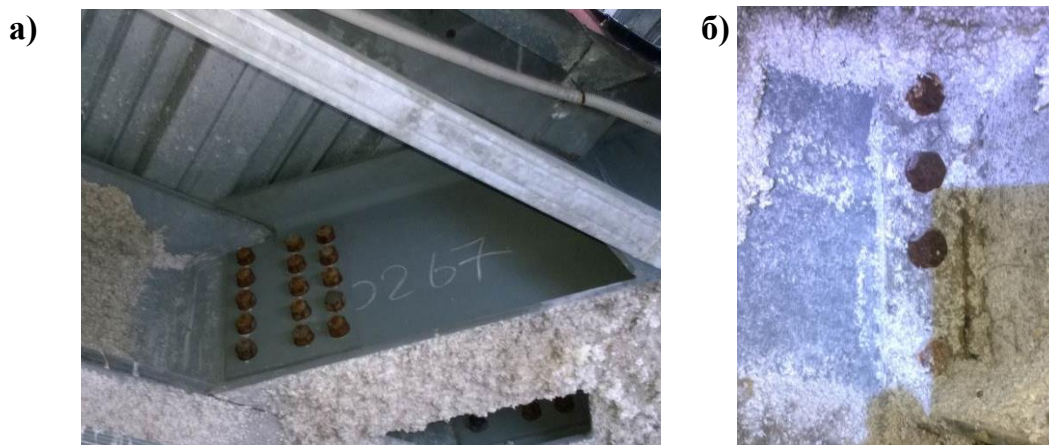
Поверхностная коррозия болтов, гаек в узлах сопряжения балок на 8-м этаже: а) на накладках; б) на уголках
